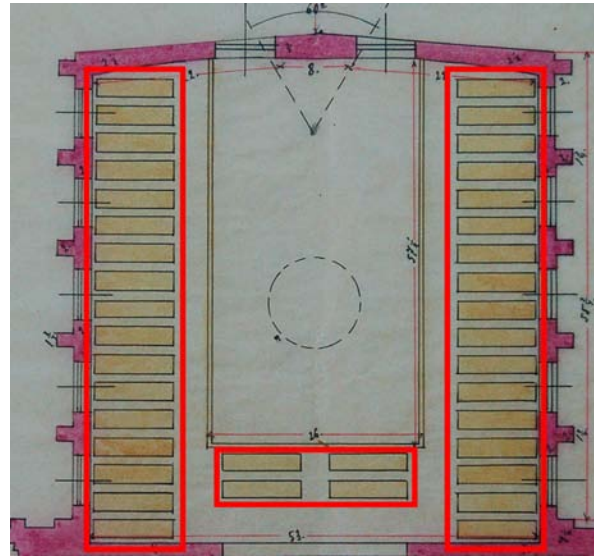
Markierungen der Sitzbänke, Plan 1.OG, Archiv
